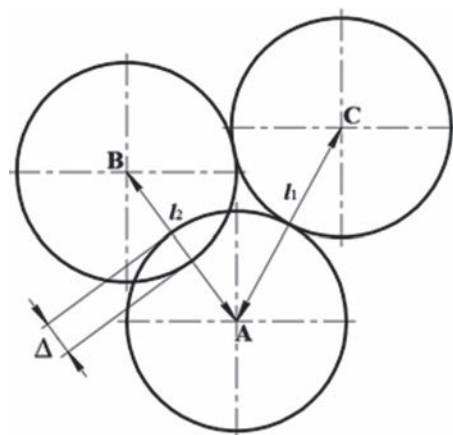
Схема для расчета длины отрезков трубопровода между стаканами в окружной схеме /
